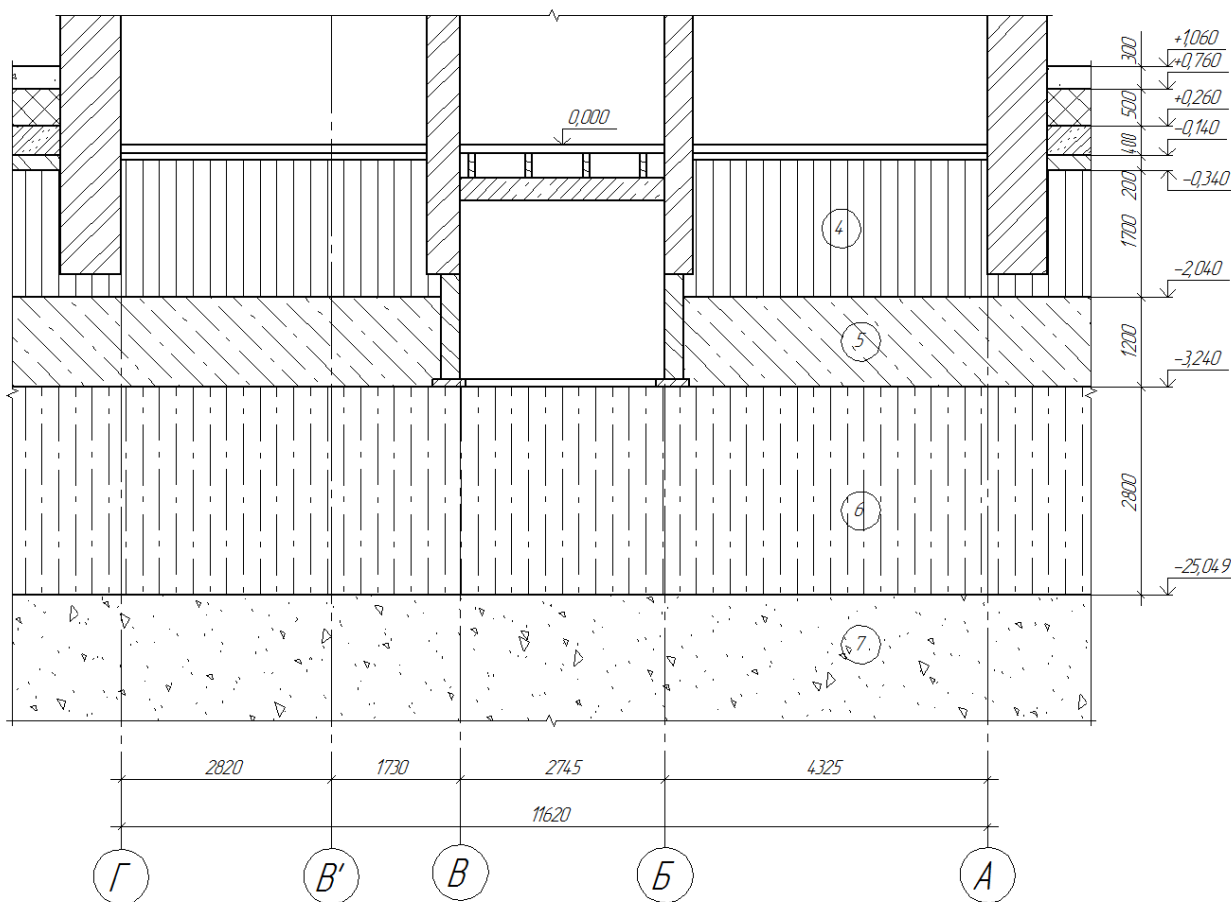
Конструктивна схема фундаментів будівлі та стін підвалу.
